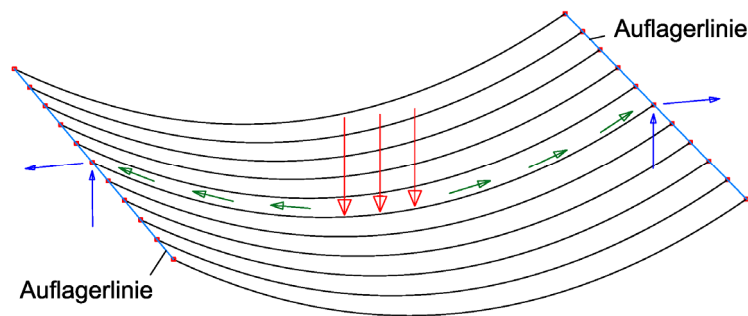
Lastabtrag bei rechteckigem Grundriss und parallelen Auflagerlinien (Isometrie)
